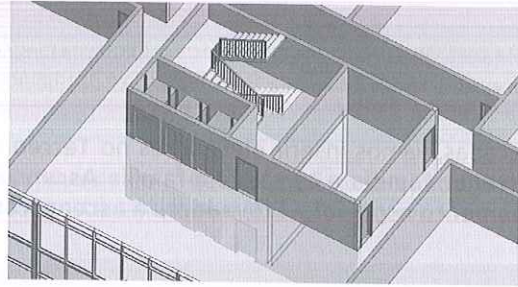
Elevadores inseridos nos dois pavimentos.
